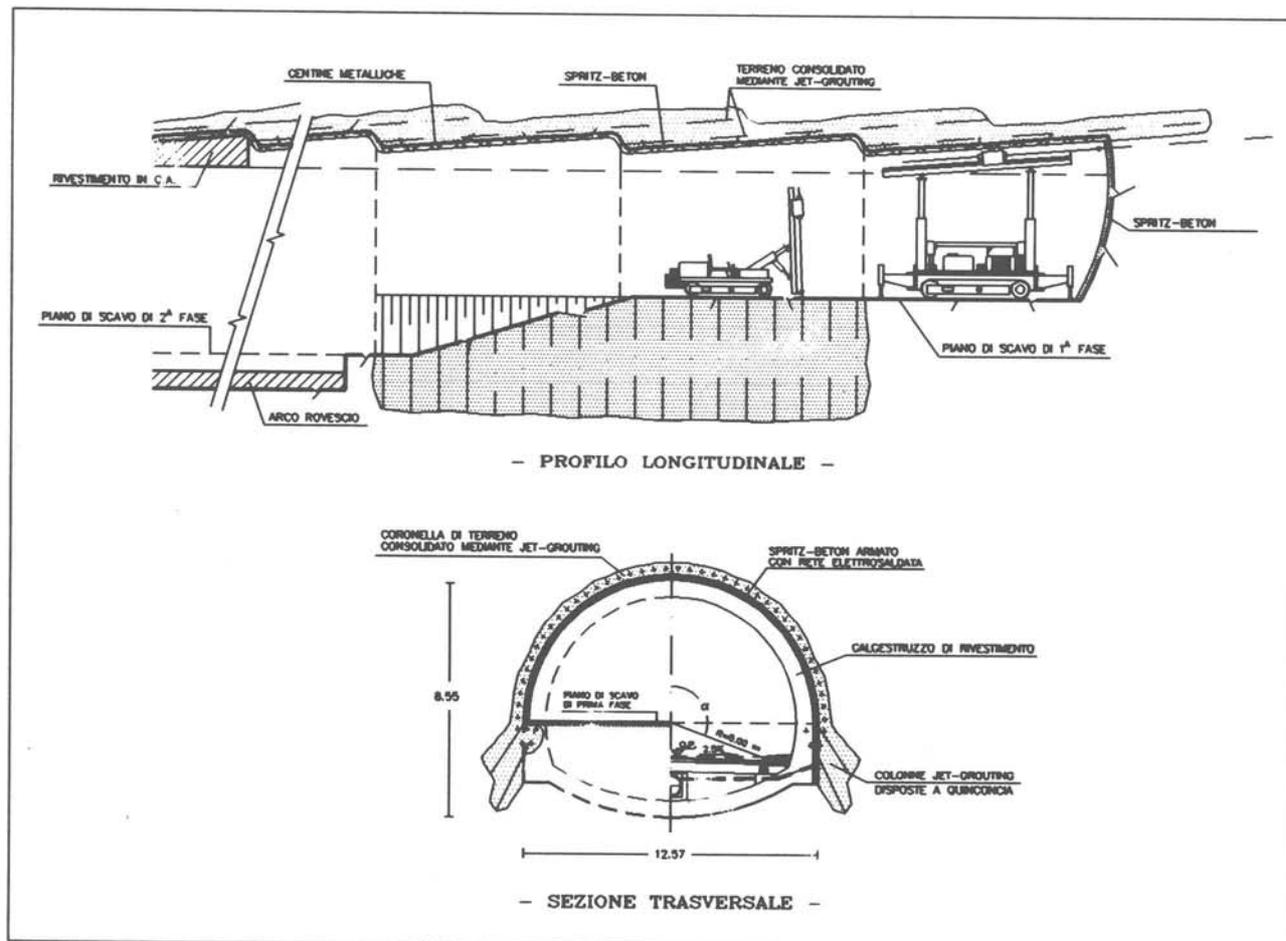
Avanzamento nella tratta d'imbocco: consolidamento con jet-grouting sub-orizzontale e sub-verticale.
